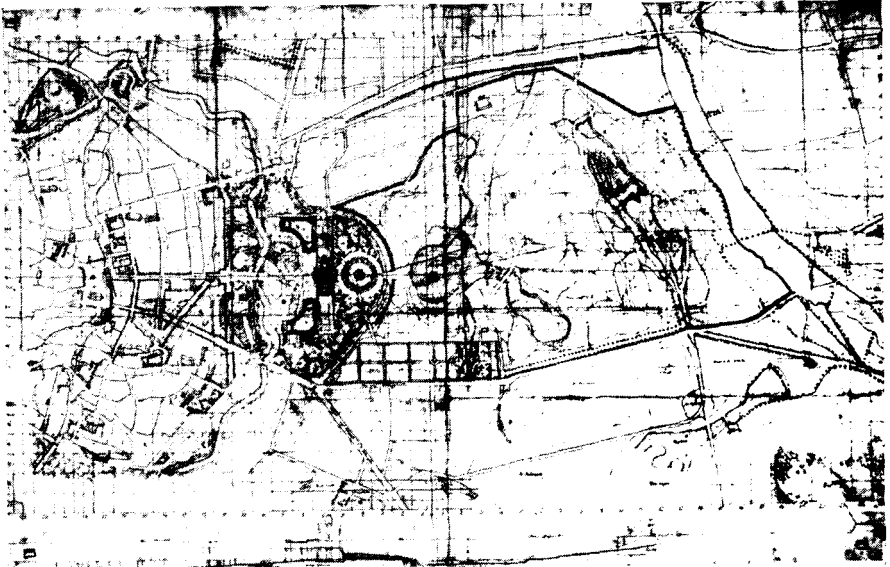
Lageplan für den Entwurf zum Neuen Schloß
